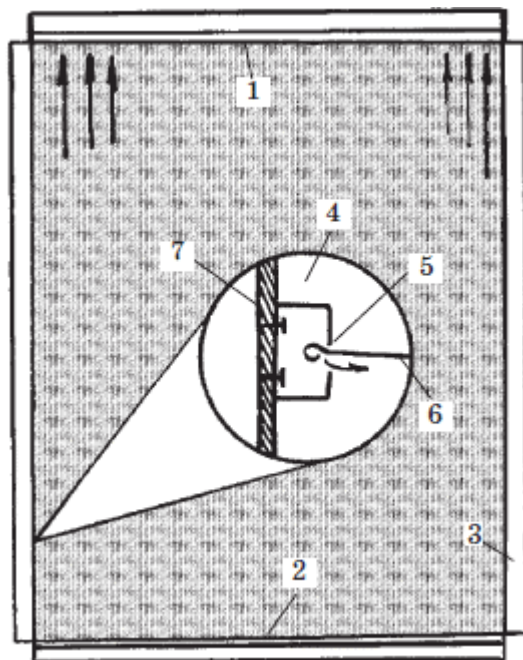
Фиксация боковых сторон потолочной пленки: 1 – натяжное крепление; 2 – рейка опорного крепления; 3 – боковые полые рейки; 4 – продольный разрез боковых реек; 5 – капроновый шнур, подшитый к боковым краям потолочной пленки; 6 – пленка; 7 – крепление боковых реек к стене
